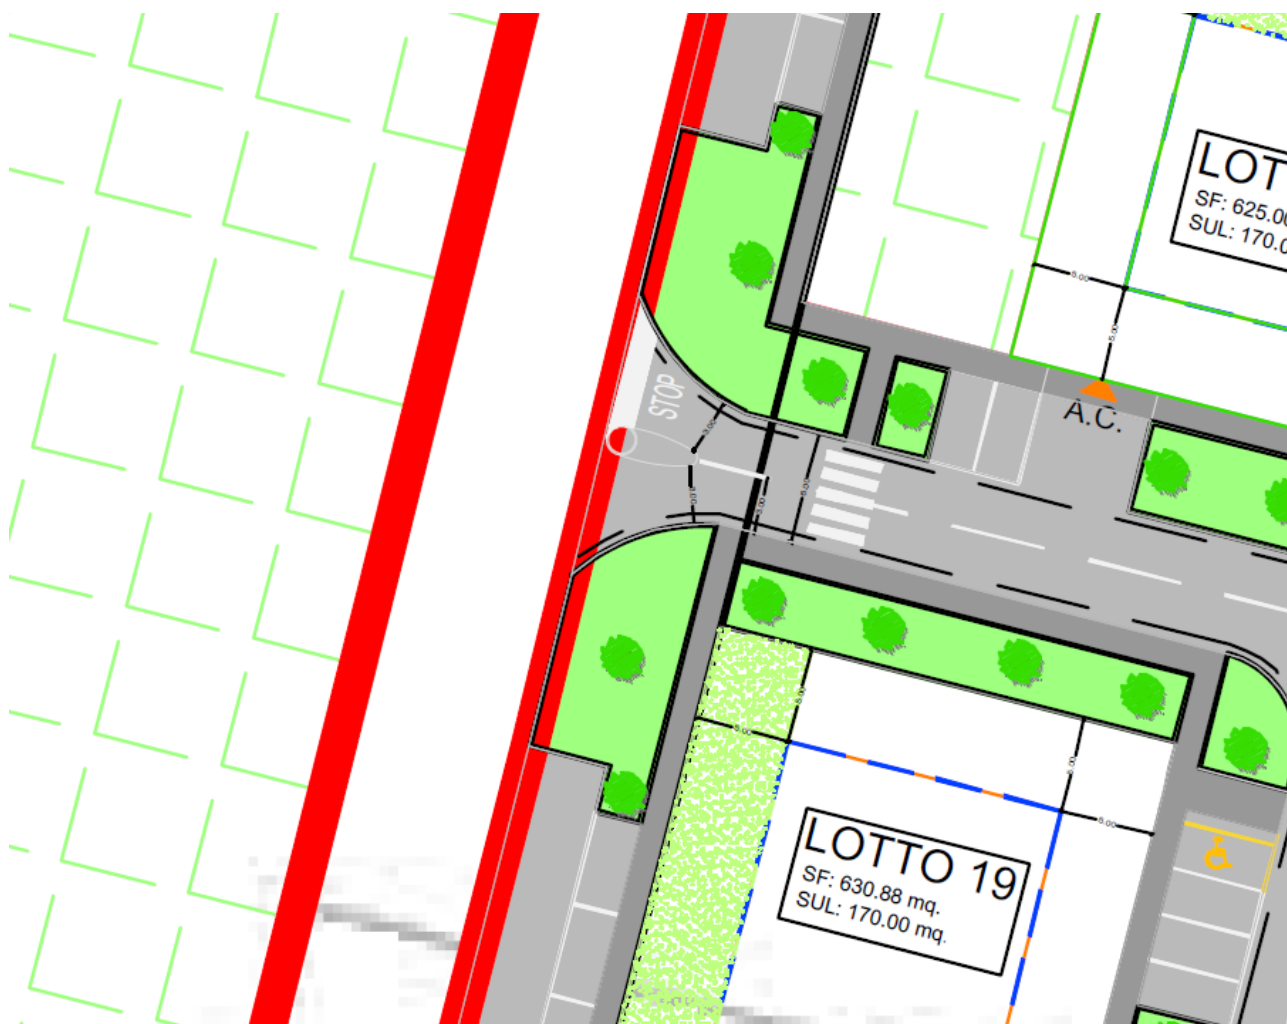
planimetria di progetto – dettaglio nuova intersezione di accesso ai lotti residenziali
